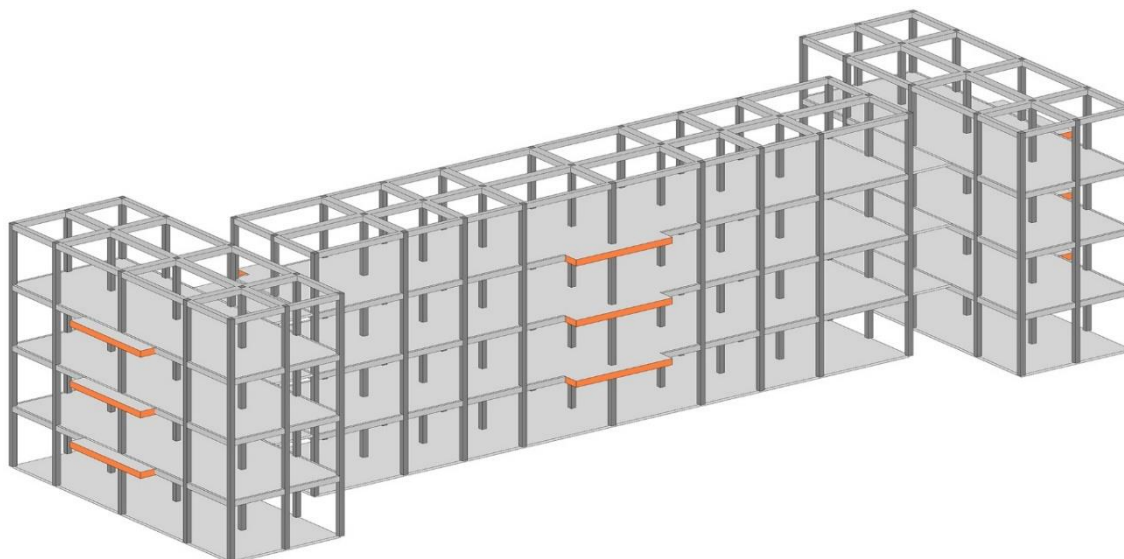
Vista assometrica tridimensionale della struttura portante dell'edificio
